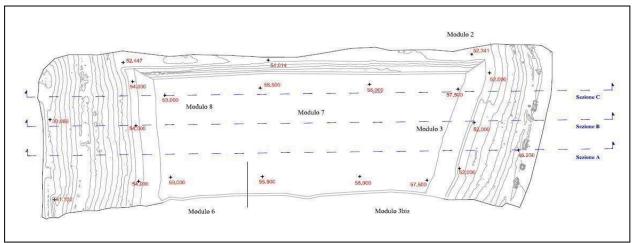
Planimetria aree sopraelevazione sui moduli 3, 7 e 8
